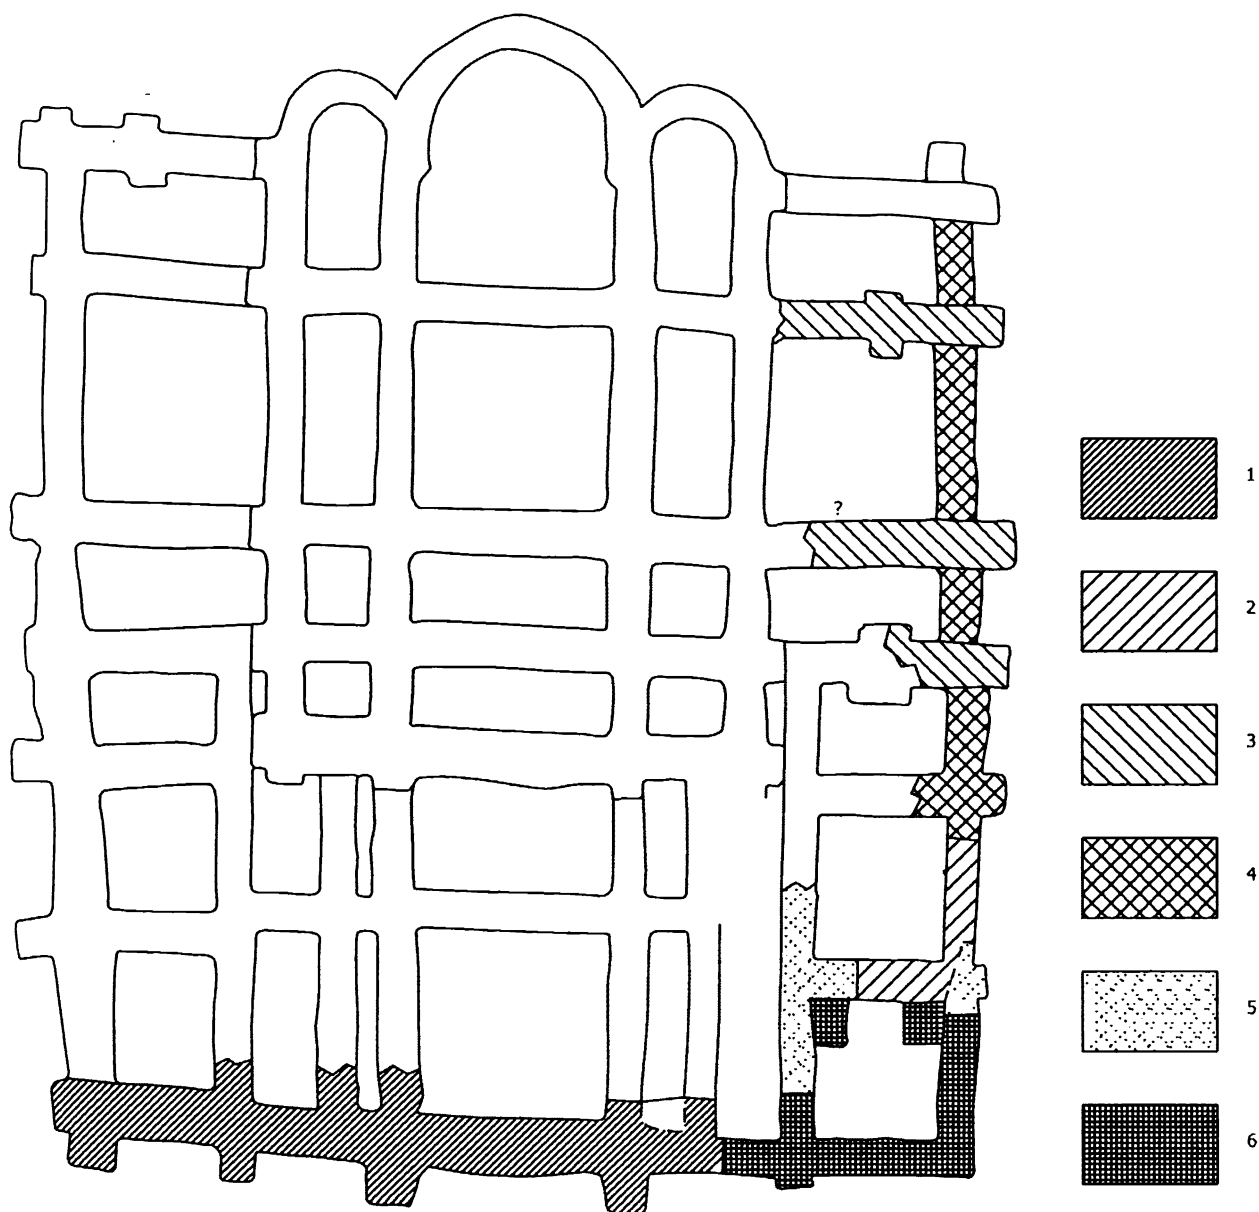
Сохранившаяся кладка фундаментов Десятинной церкви и основные группы строительных материалов.
